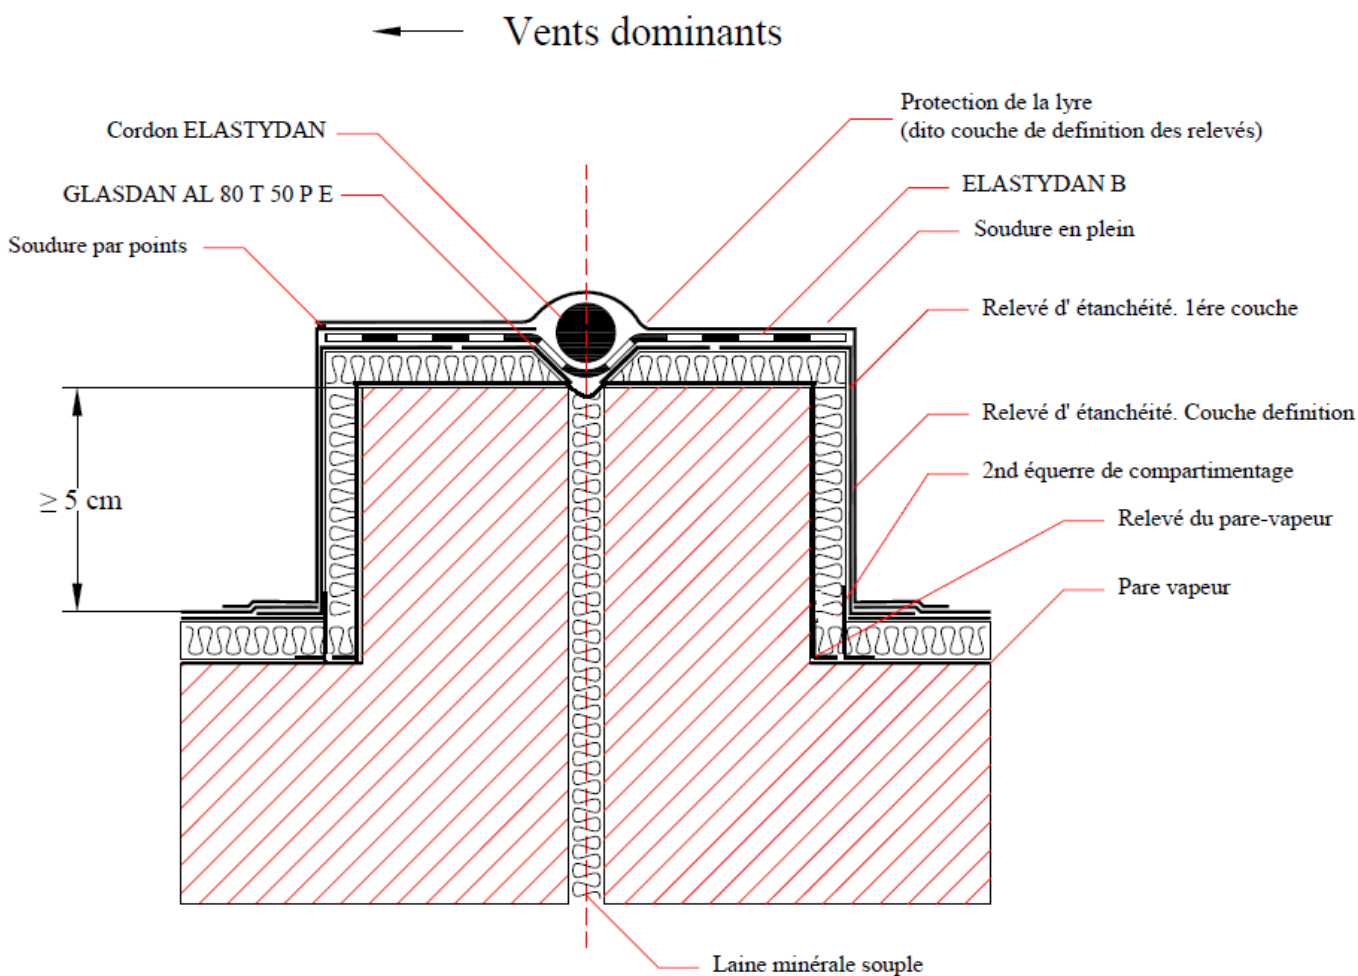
Butées maçonnées en toiture accessible piéton sous protection dure sur mortier
